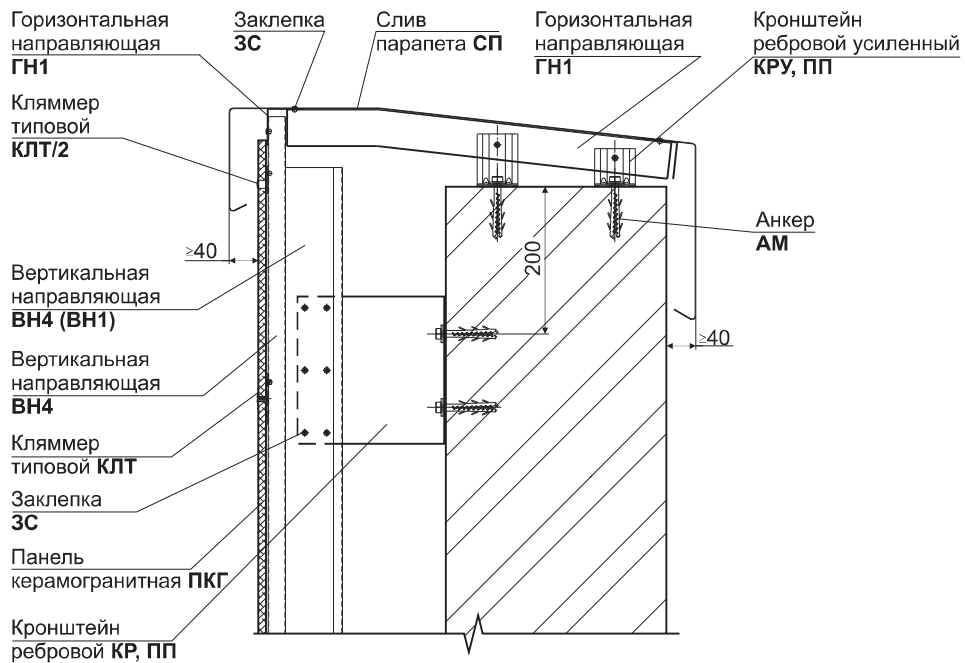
Узел облицовки парапета. Вариант крепления системы к междуэтажным перекрытиям.
